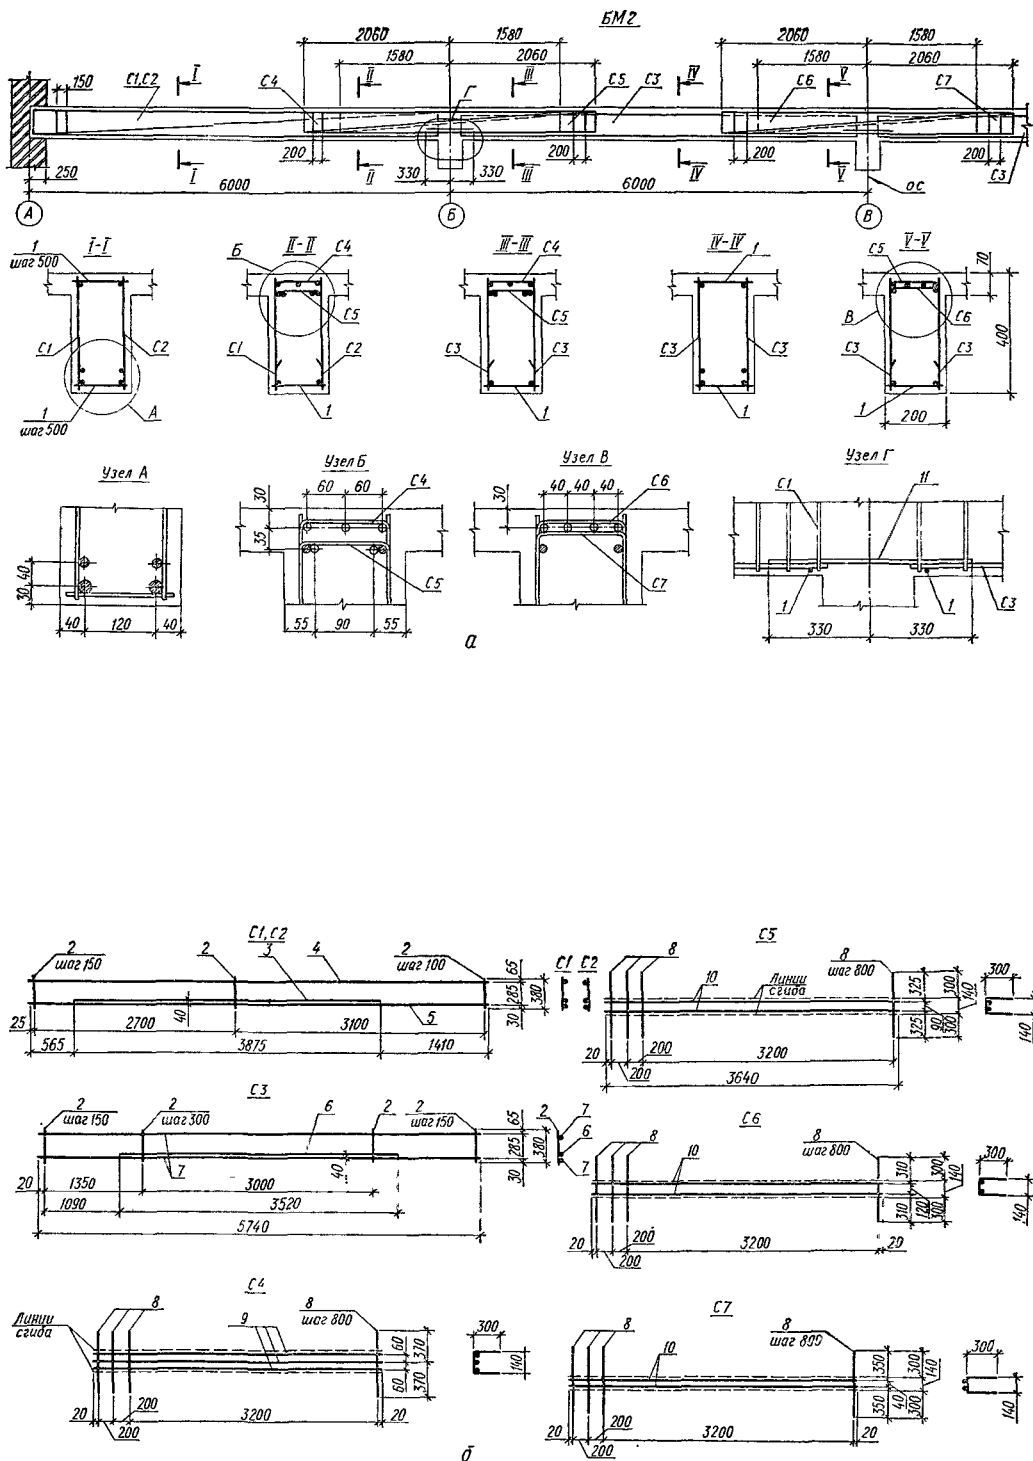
Армирование второстепенной Салки сварными сетками:
